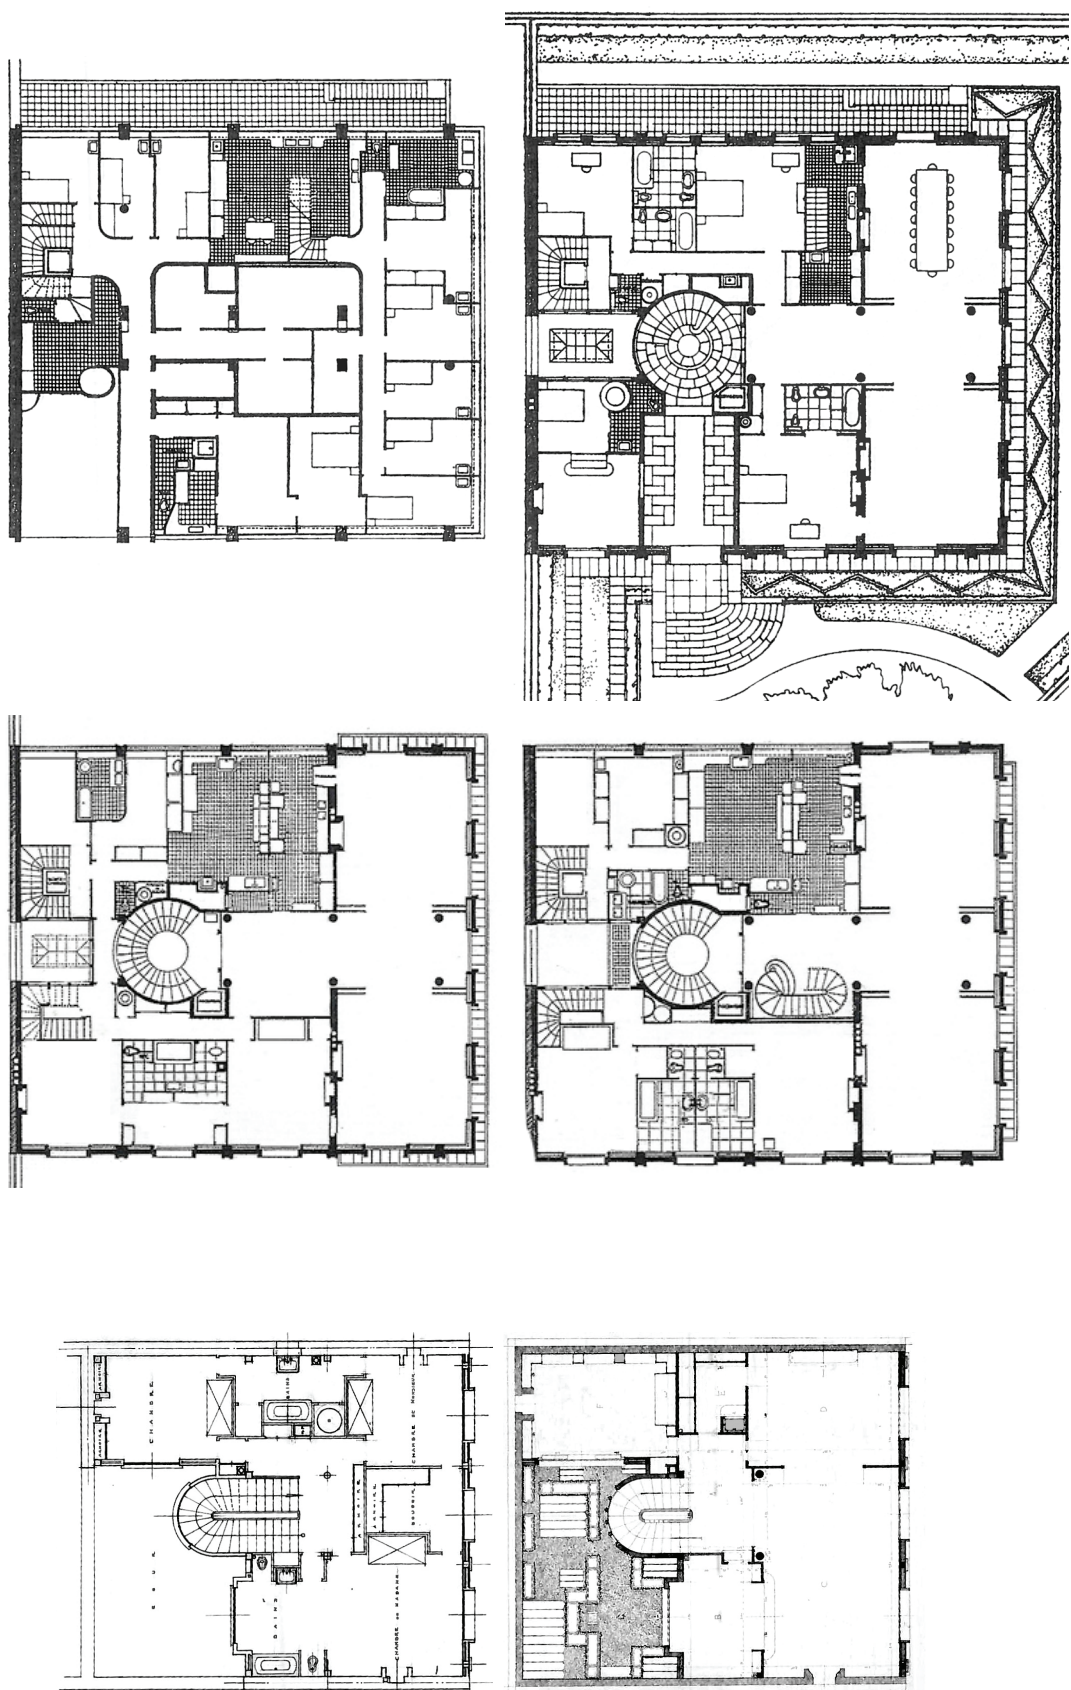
e 47. Planta do piso da garagem e planta do piso térreo
